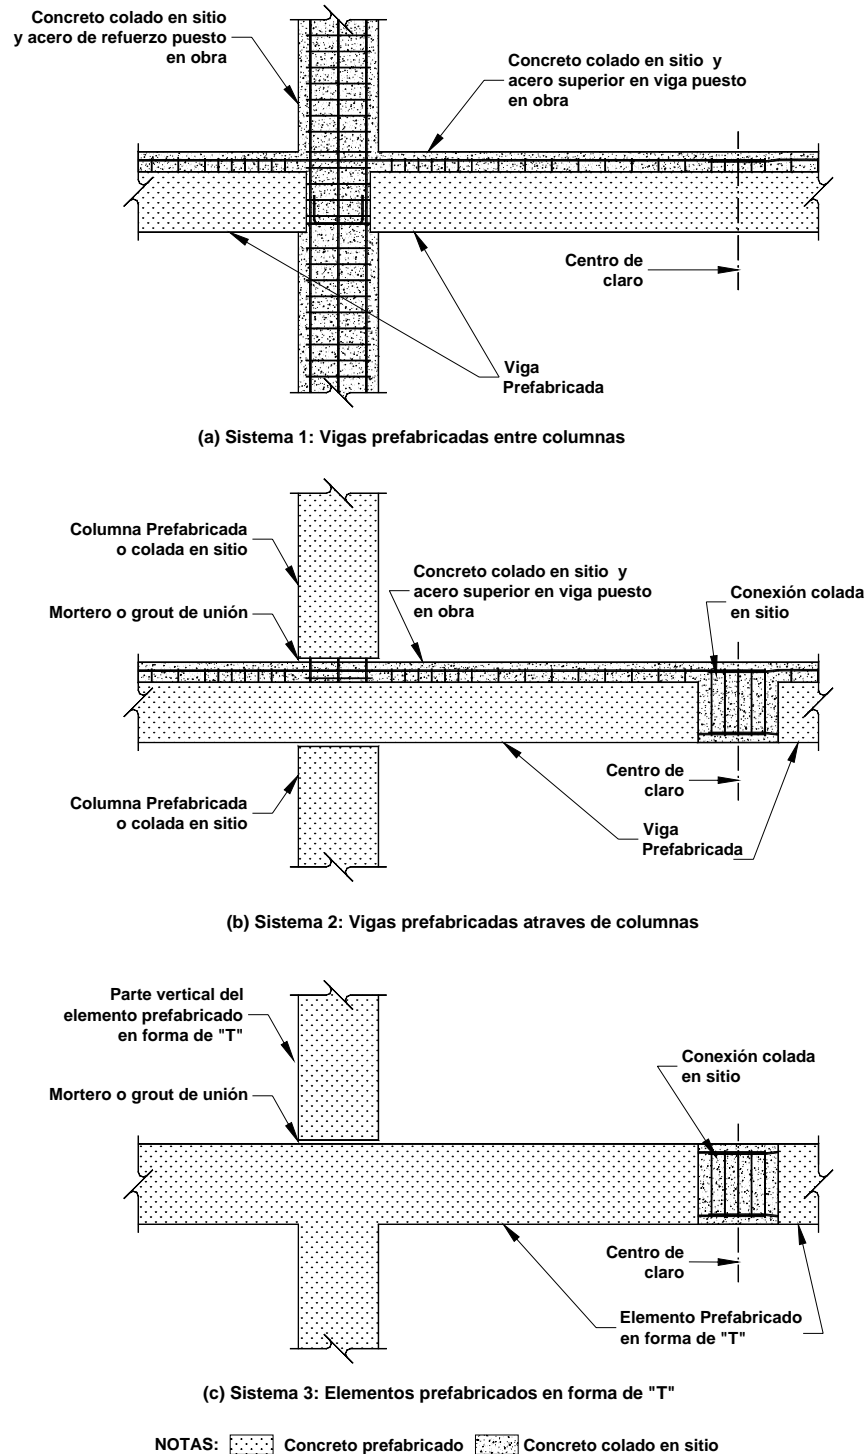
Tipos de conexiones entre elementos prefabricados [Park, 1995]
